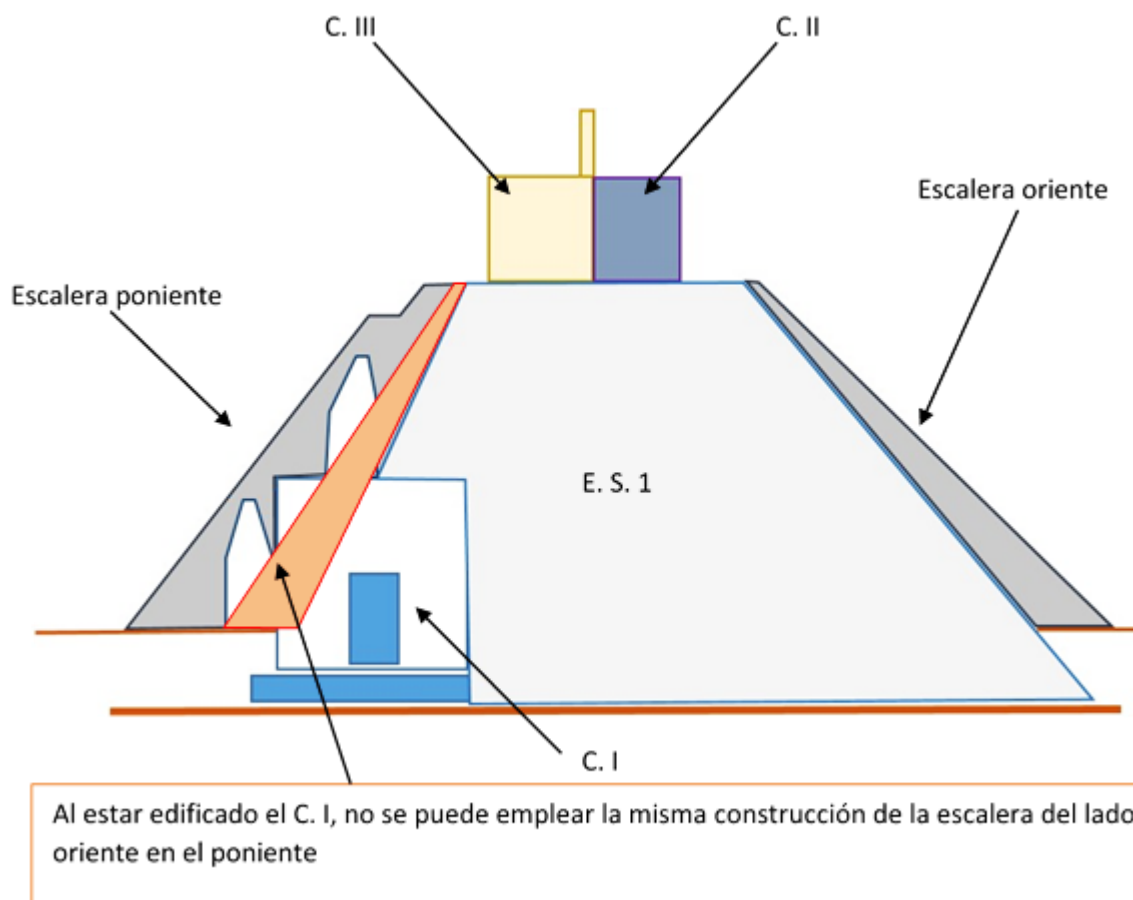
Cortés Juan. Fachada Sur de la Etapa 2, mostrando las dos escaleras y su solución constructiva de cada una. Croquis y Modelos 3D. 1016. Acervo J. Cortés.
